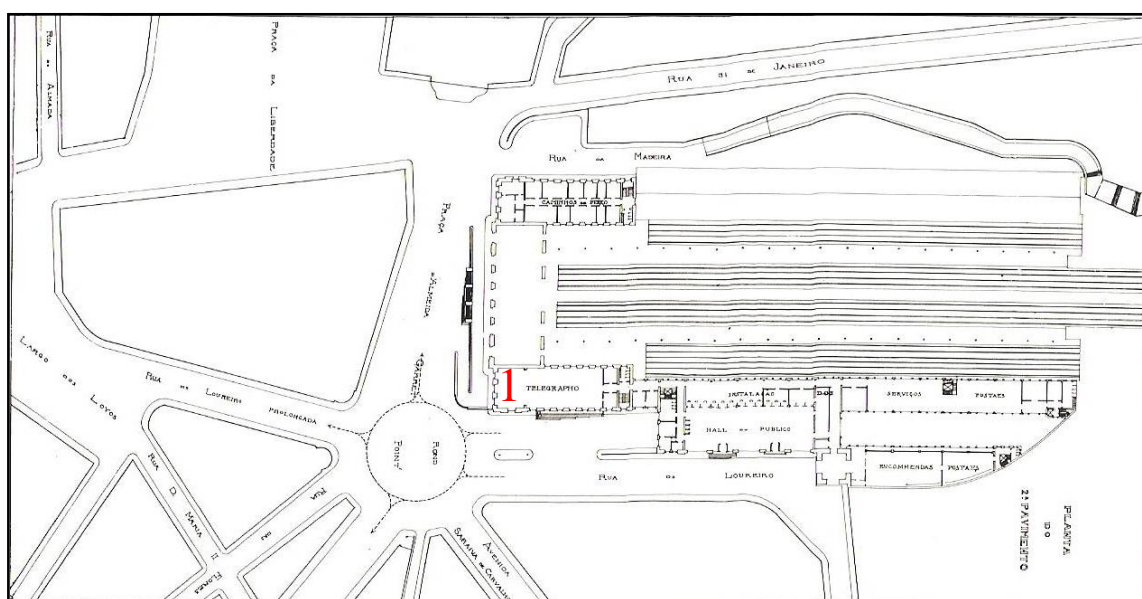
Planta do anteprojecto para a instalação dos Correios Telégrafo. Planta do 2.º pavimento e reformulação urbanística da Praça Almeida Garrett
